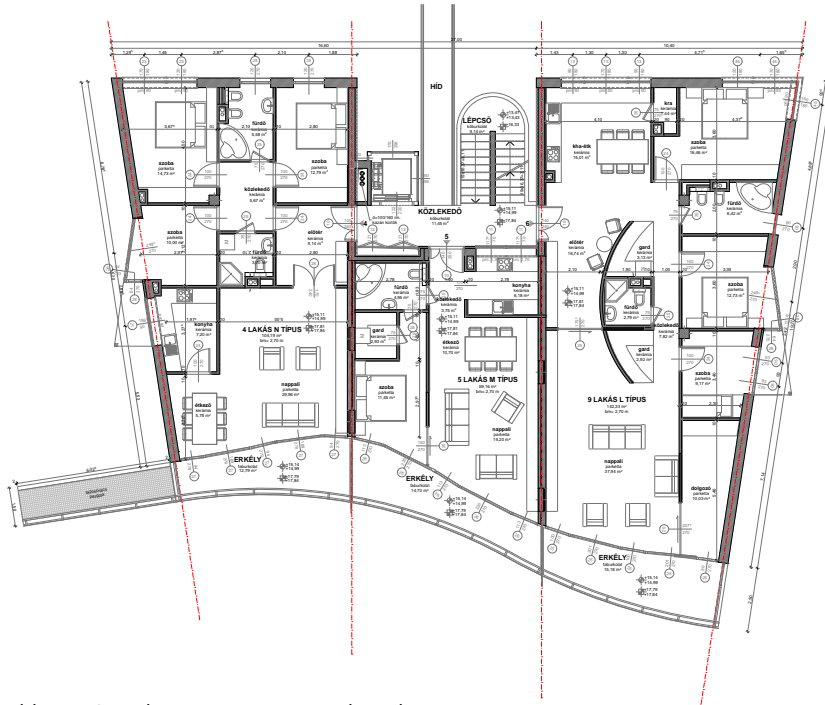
Grundriss von einem Regelgeschoss
